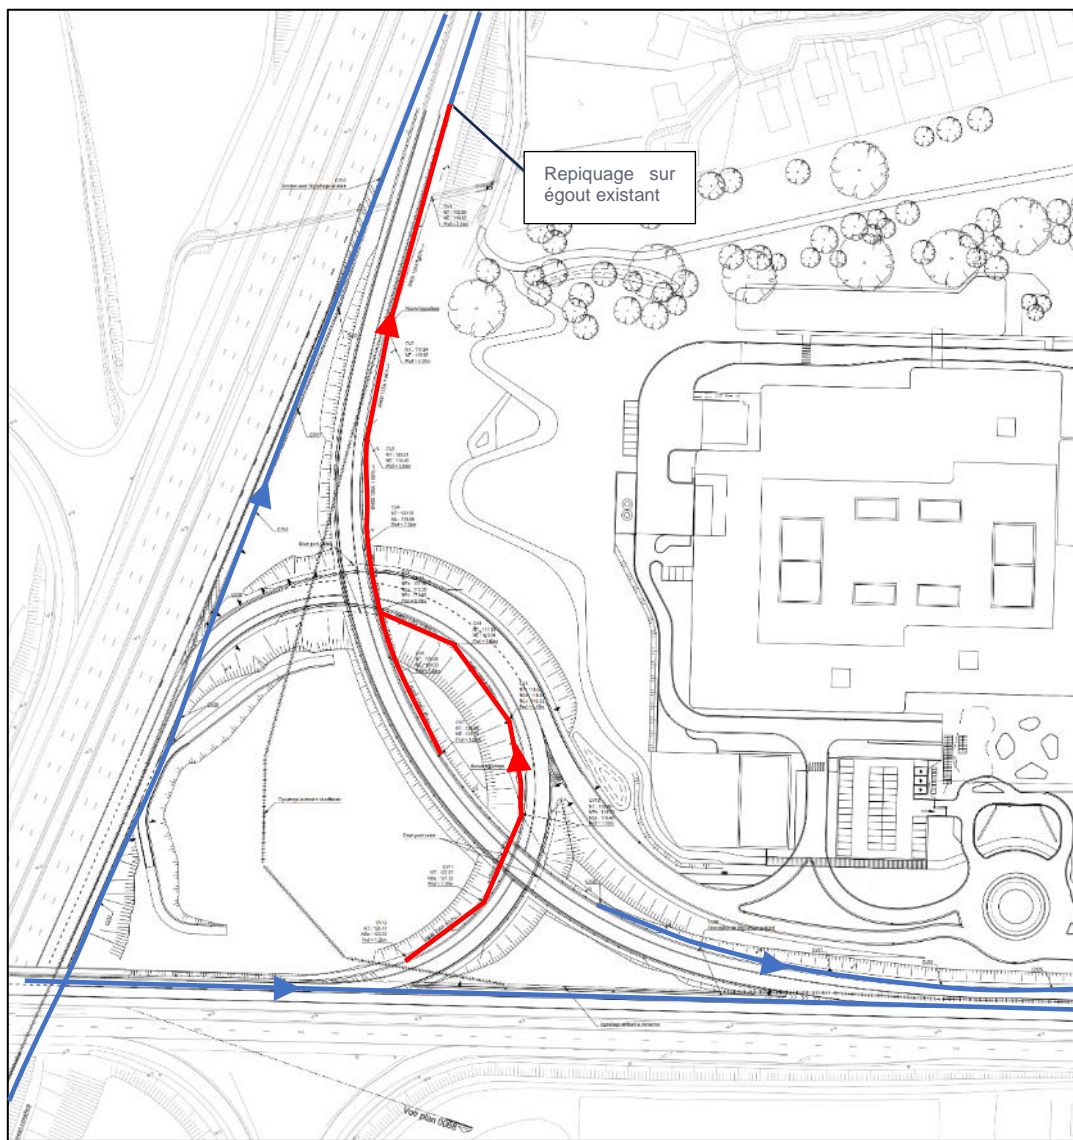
schéma d'égouttage de la bretelle d'autoroute
